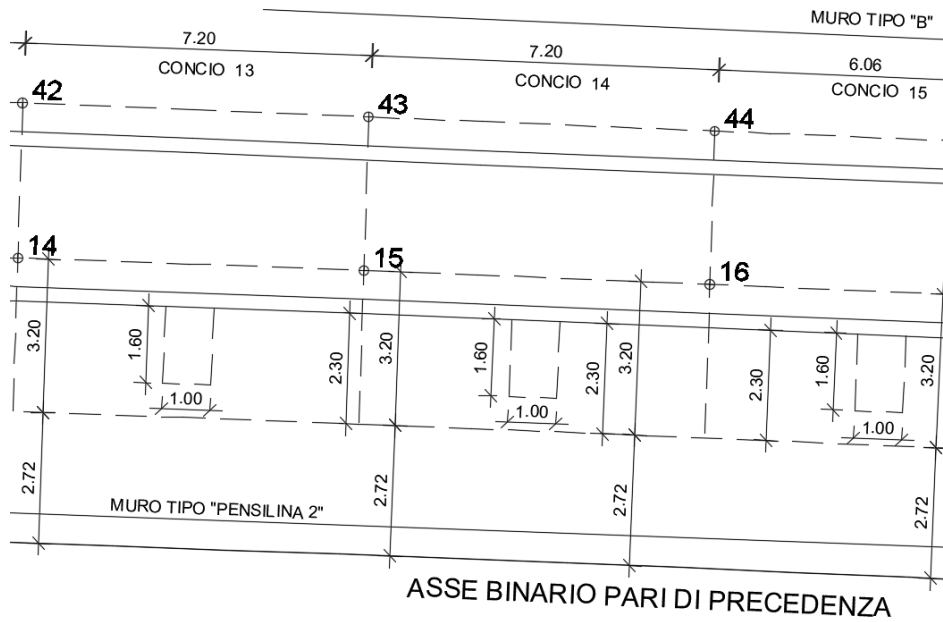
Stralcio planimetrico pensilina su "pensilina tipo 2 - FV01"
